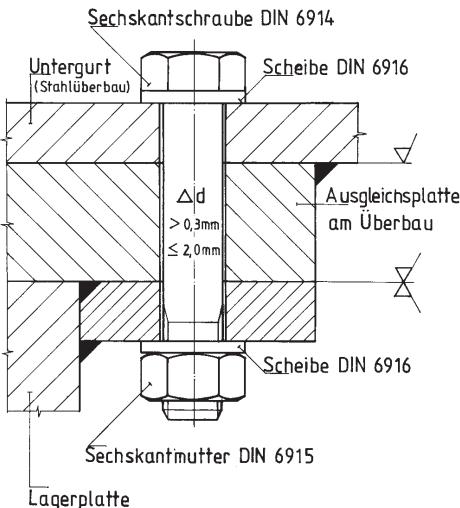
Planmäßig vorgespannte hochfeste Schraubenverbindung
